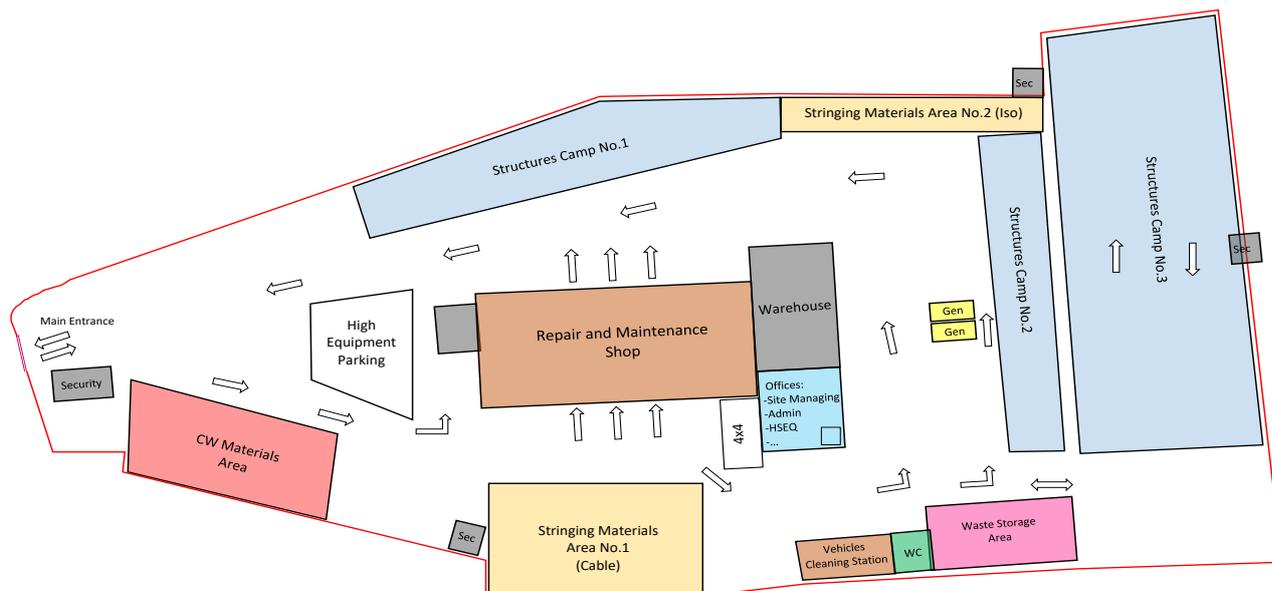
Plan-type de dépôt de stockage (Source : Elecnor, 2024)
